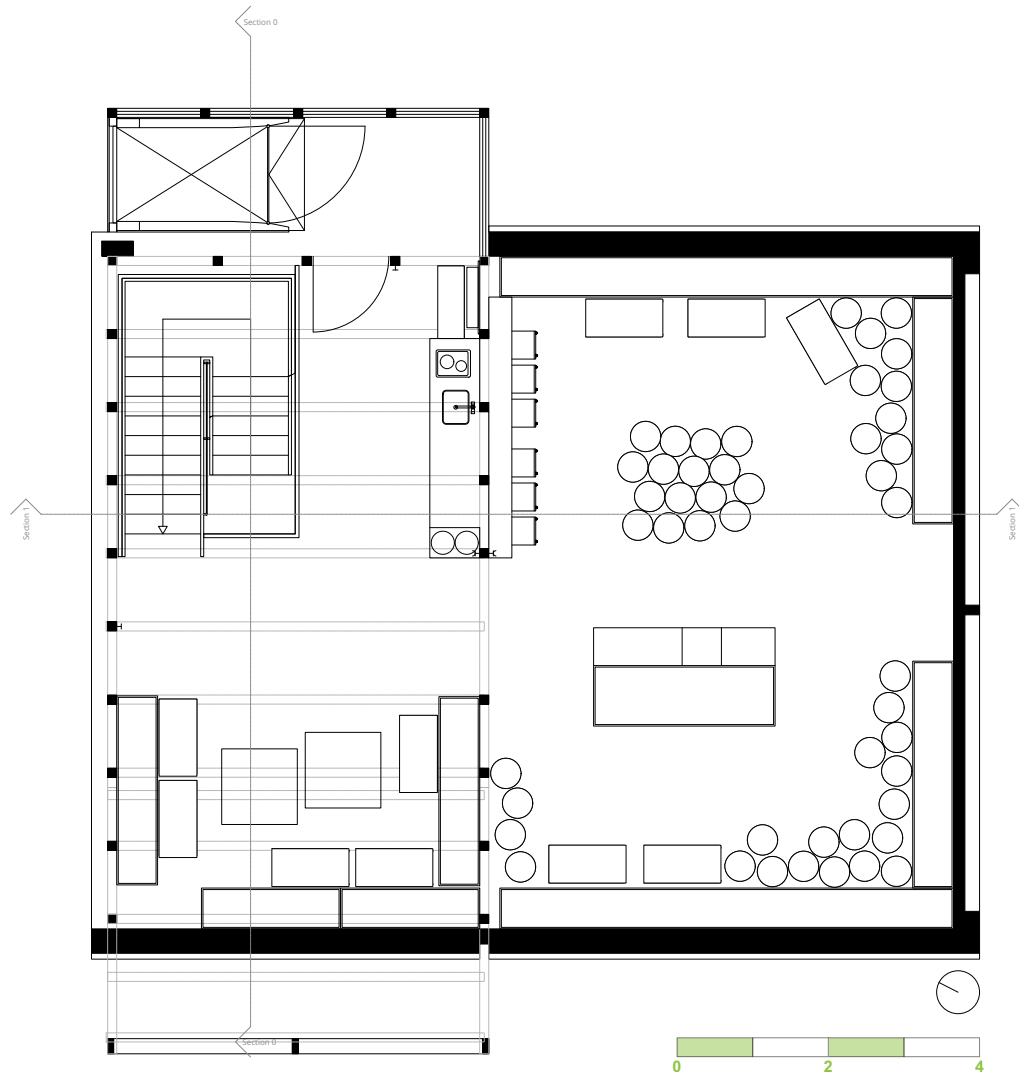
Grundriss Rooftop | M 1:100
